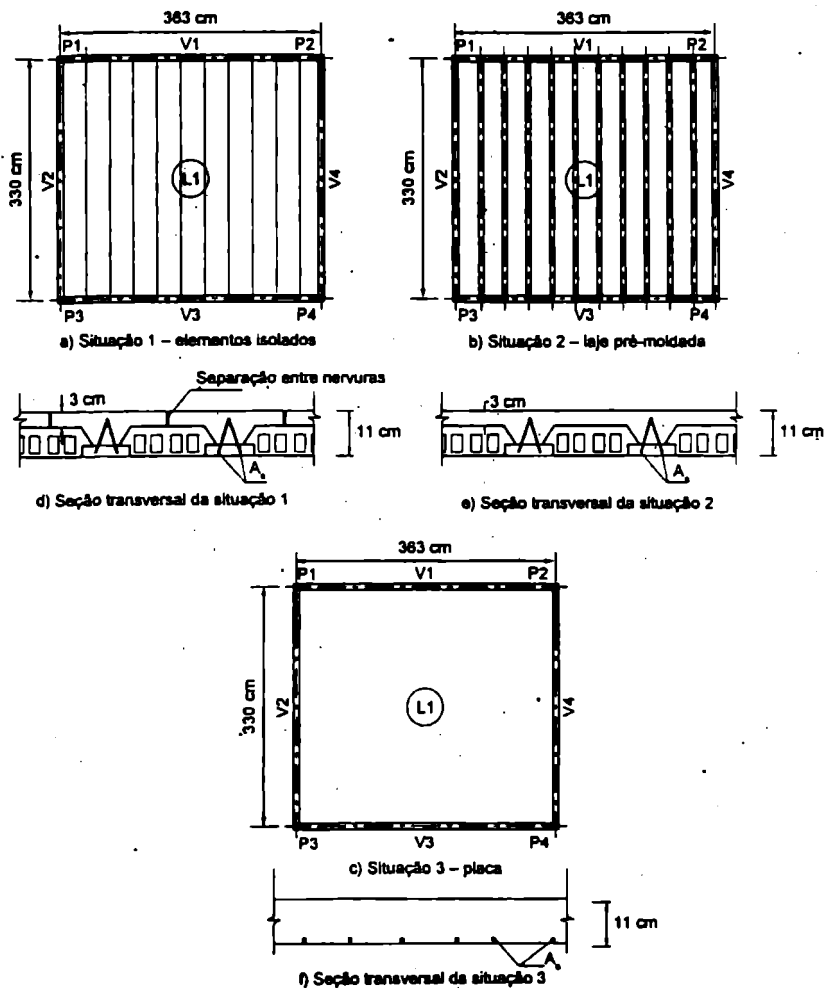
Situações analisadas: elementos isolados, laje pré-moldada e laje maciça.
